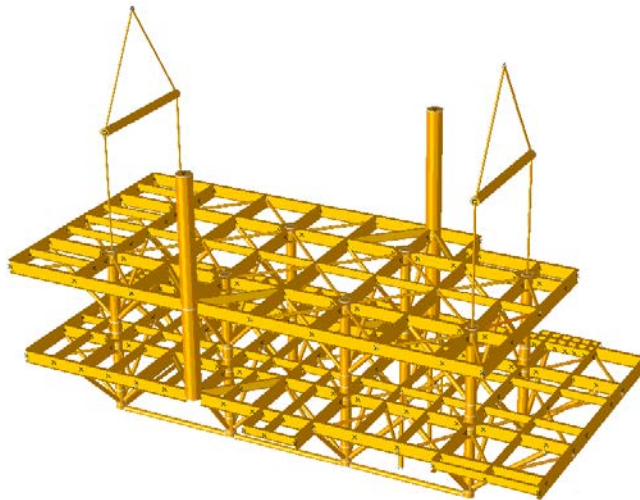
Ejemplo de modelo estructural tridimensional del izaje de una superestructura.
